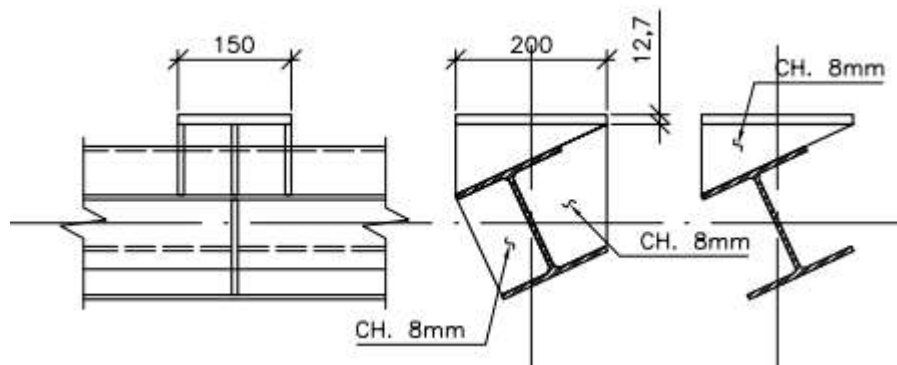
Croqui dos pontos de apoio e aplicação de carga
